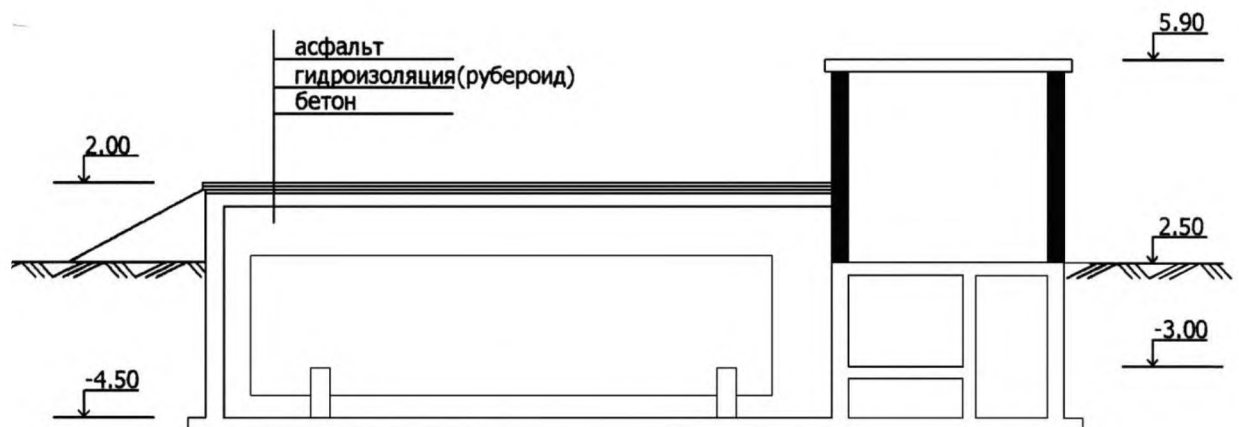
Вертикальный разрез хранилища жидких отходов (ХЖО № 1)
